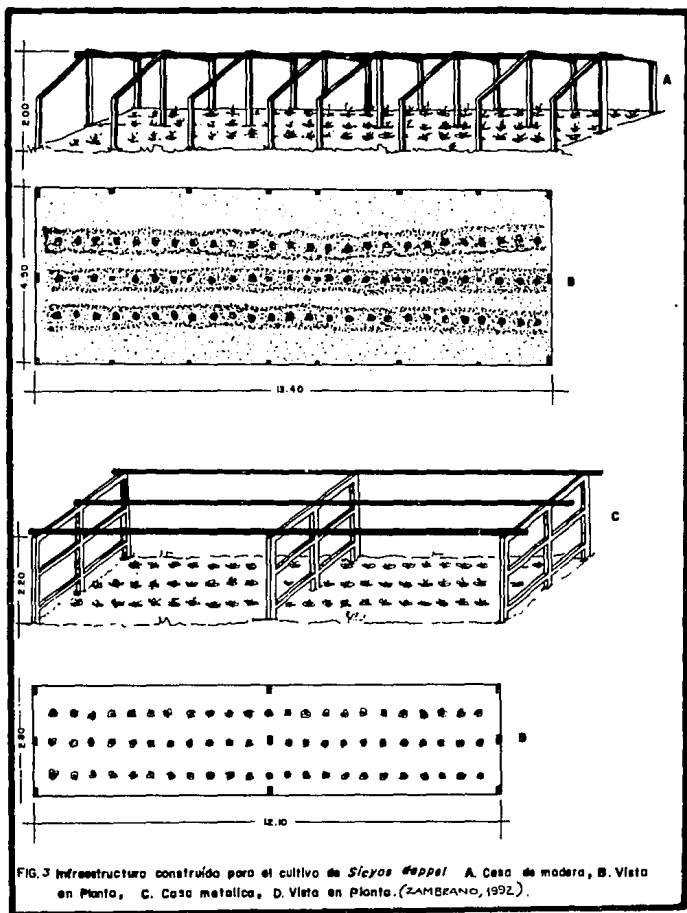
Infraestructura construída para el cultivo de *Sicyos #eppei*. A. Casa de madera, B. Vista en Planta, C. Casa metálica, D. Vista en Planta. (ZAMBRANO, 1992).
